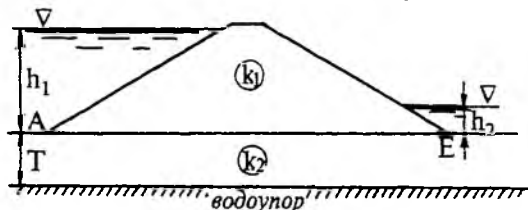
Грунтовая плотина на водопроницаемом основании
